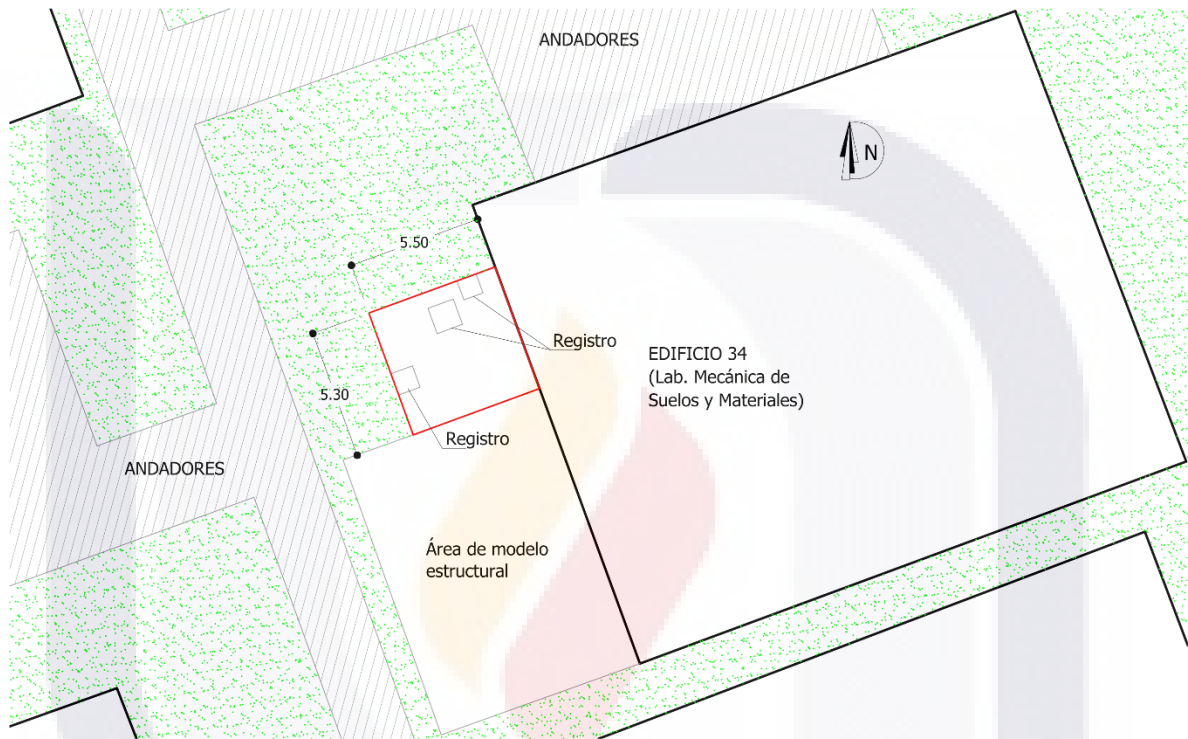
Vista en planta del croquis de localización del área de trabajo.
